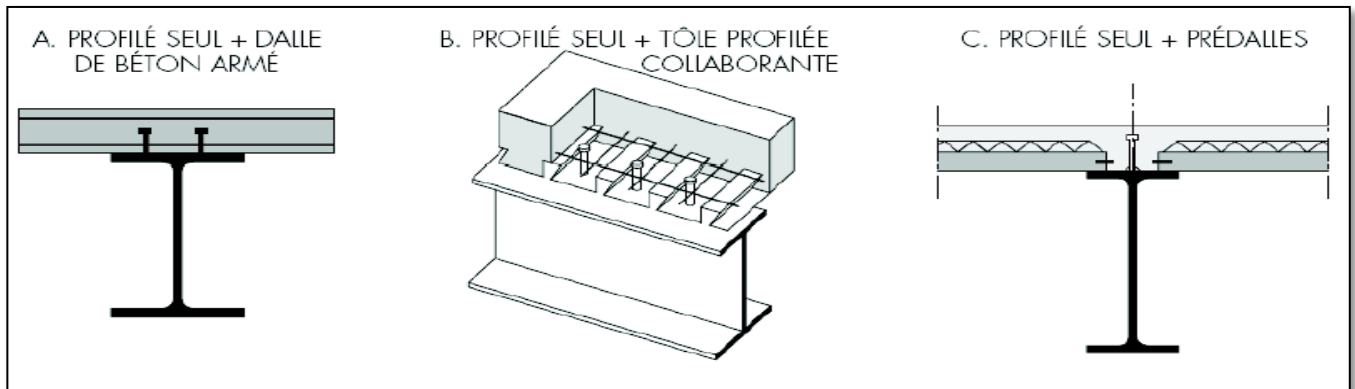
Les Poutres Mixtes (Source: Cours Mr Boukhelkhal)
